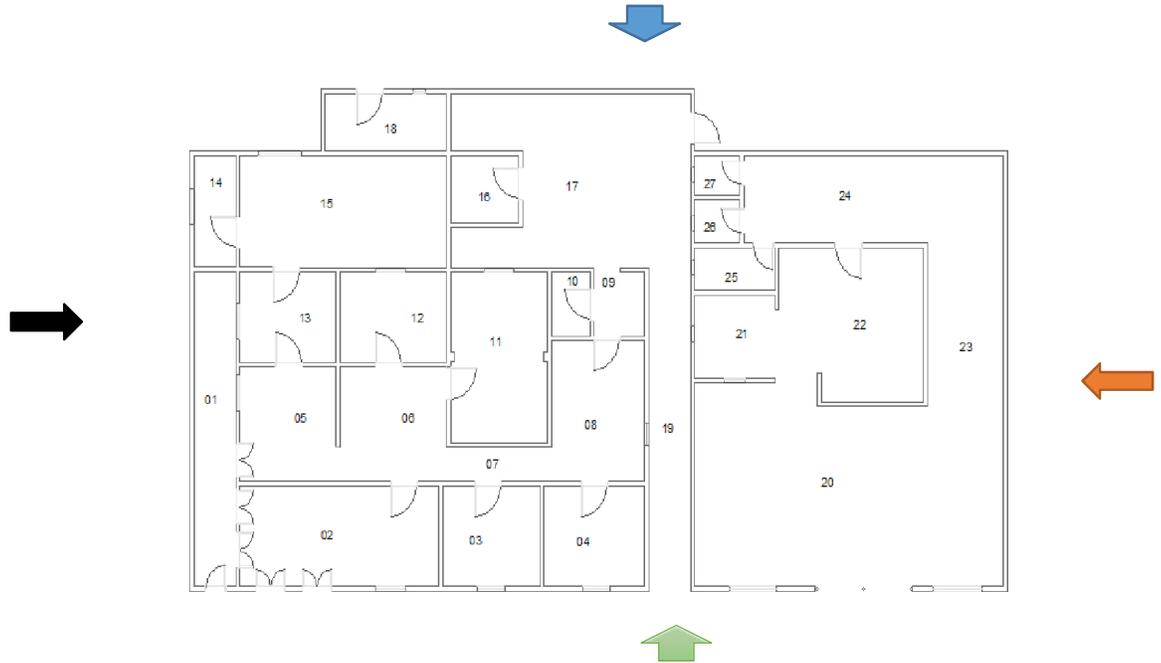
Planta Baixa Fonte: Acervo Próprio;
